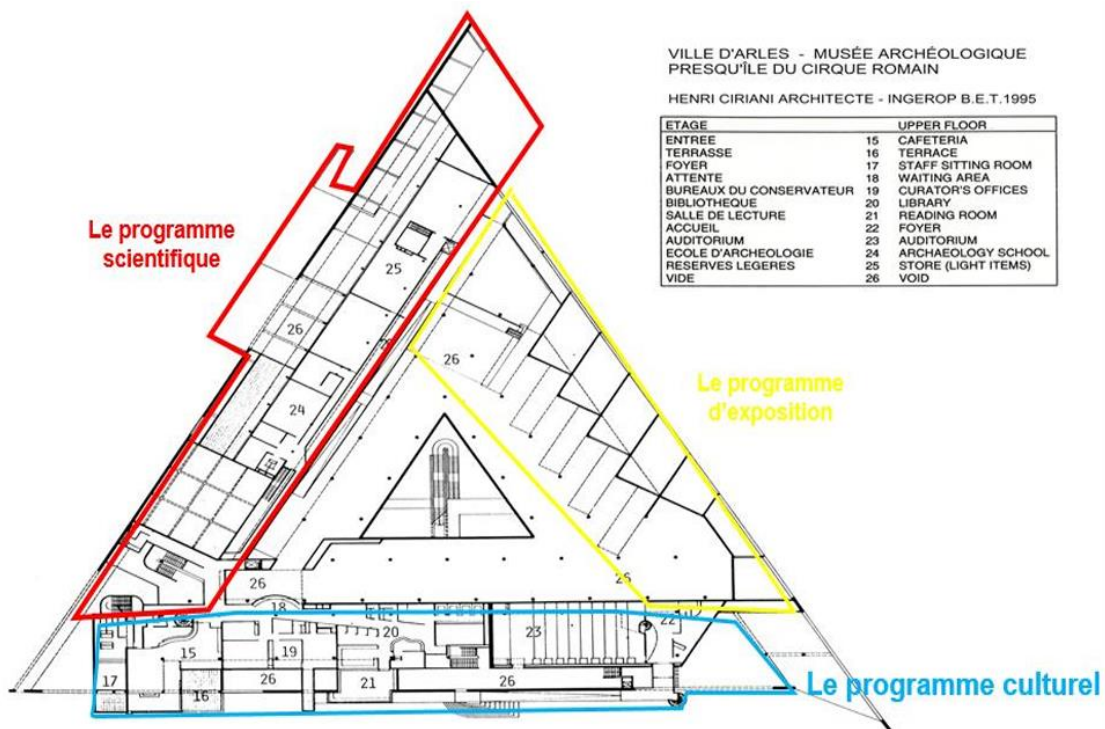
18. Plan du 1<sup>er</sup> étage
